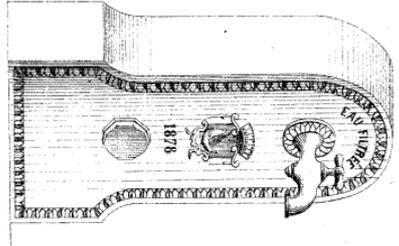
Conduite en béton de ciment de la Forêt de France.
